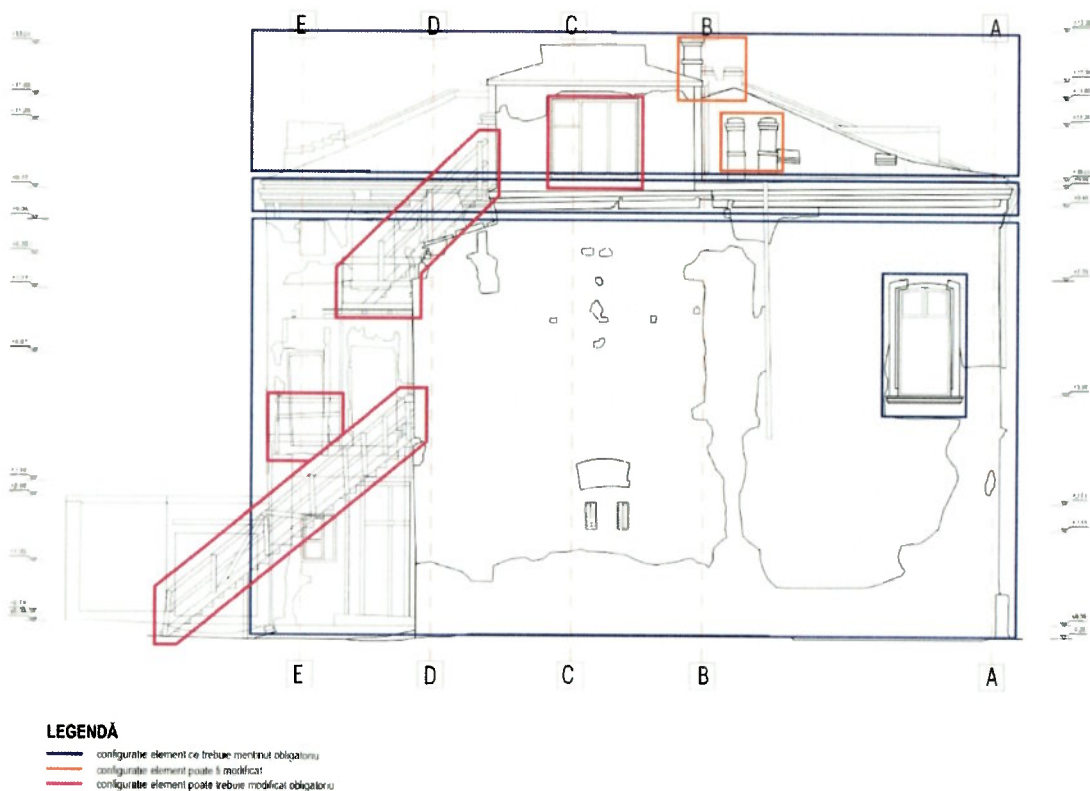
Fațadă laterală stânga (vest, sud-vest) – atitudini față de elementele construcției
